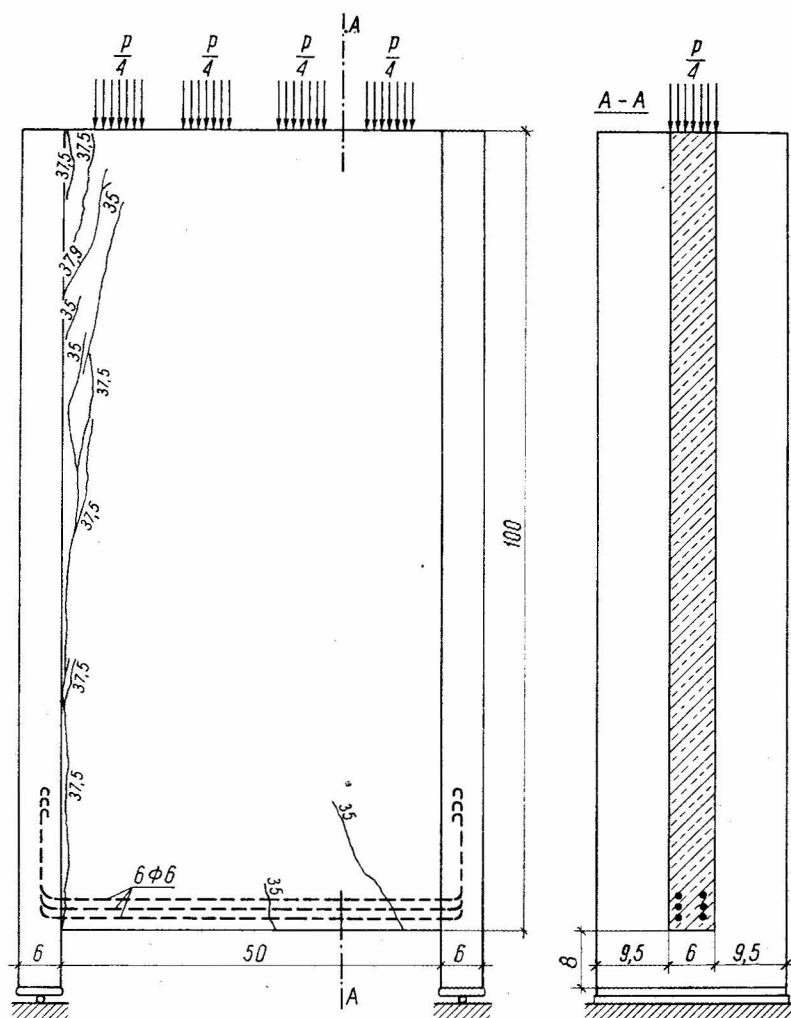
Fissuration dans une poutre-cloison lors de la rupture par coupure
